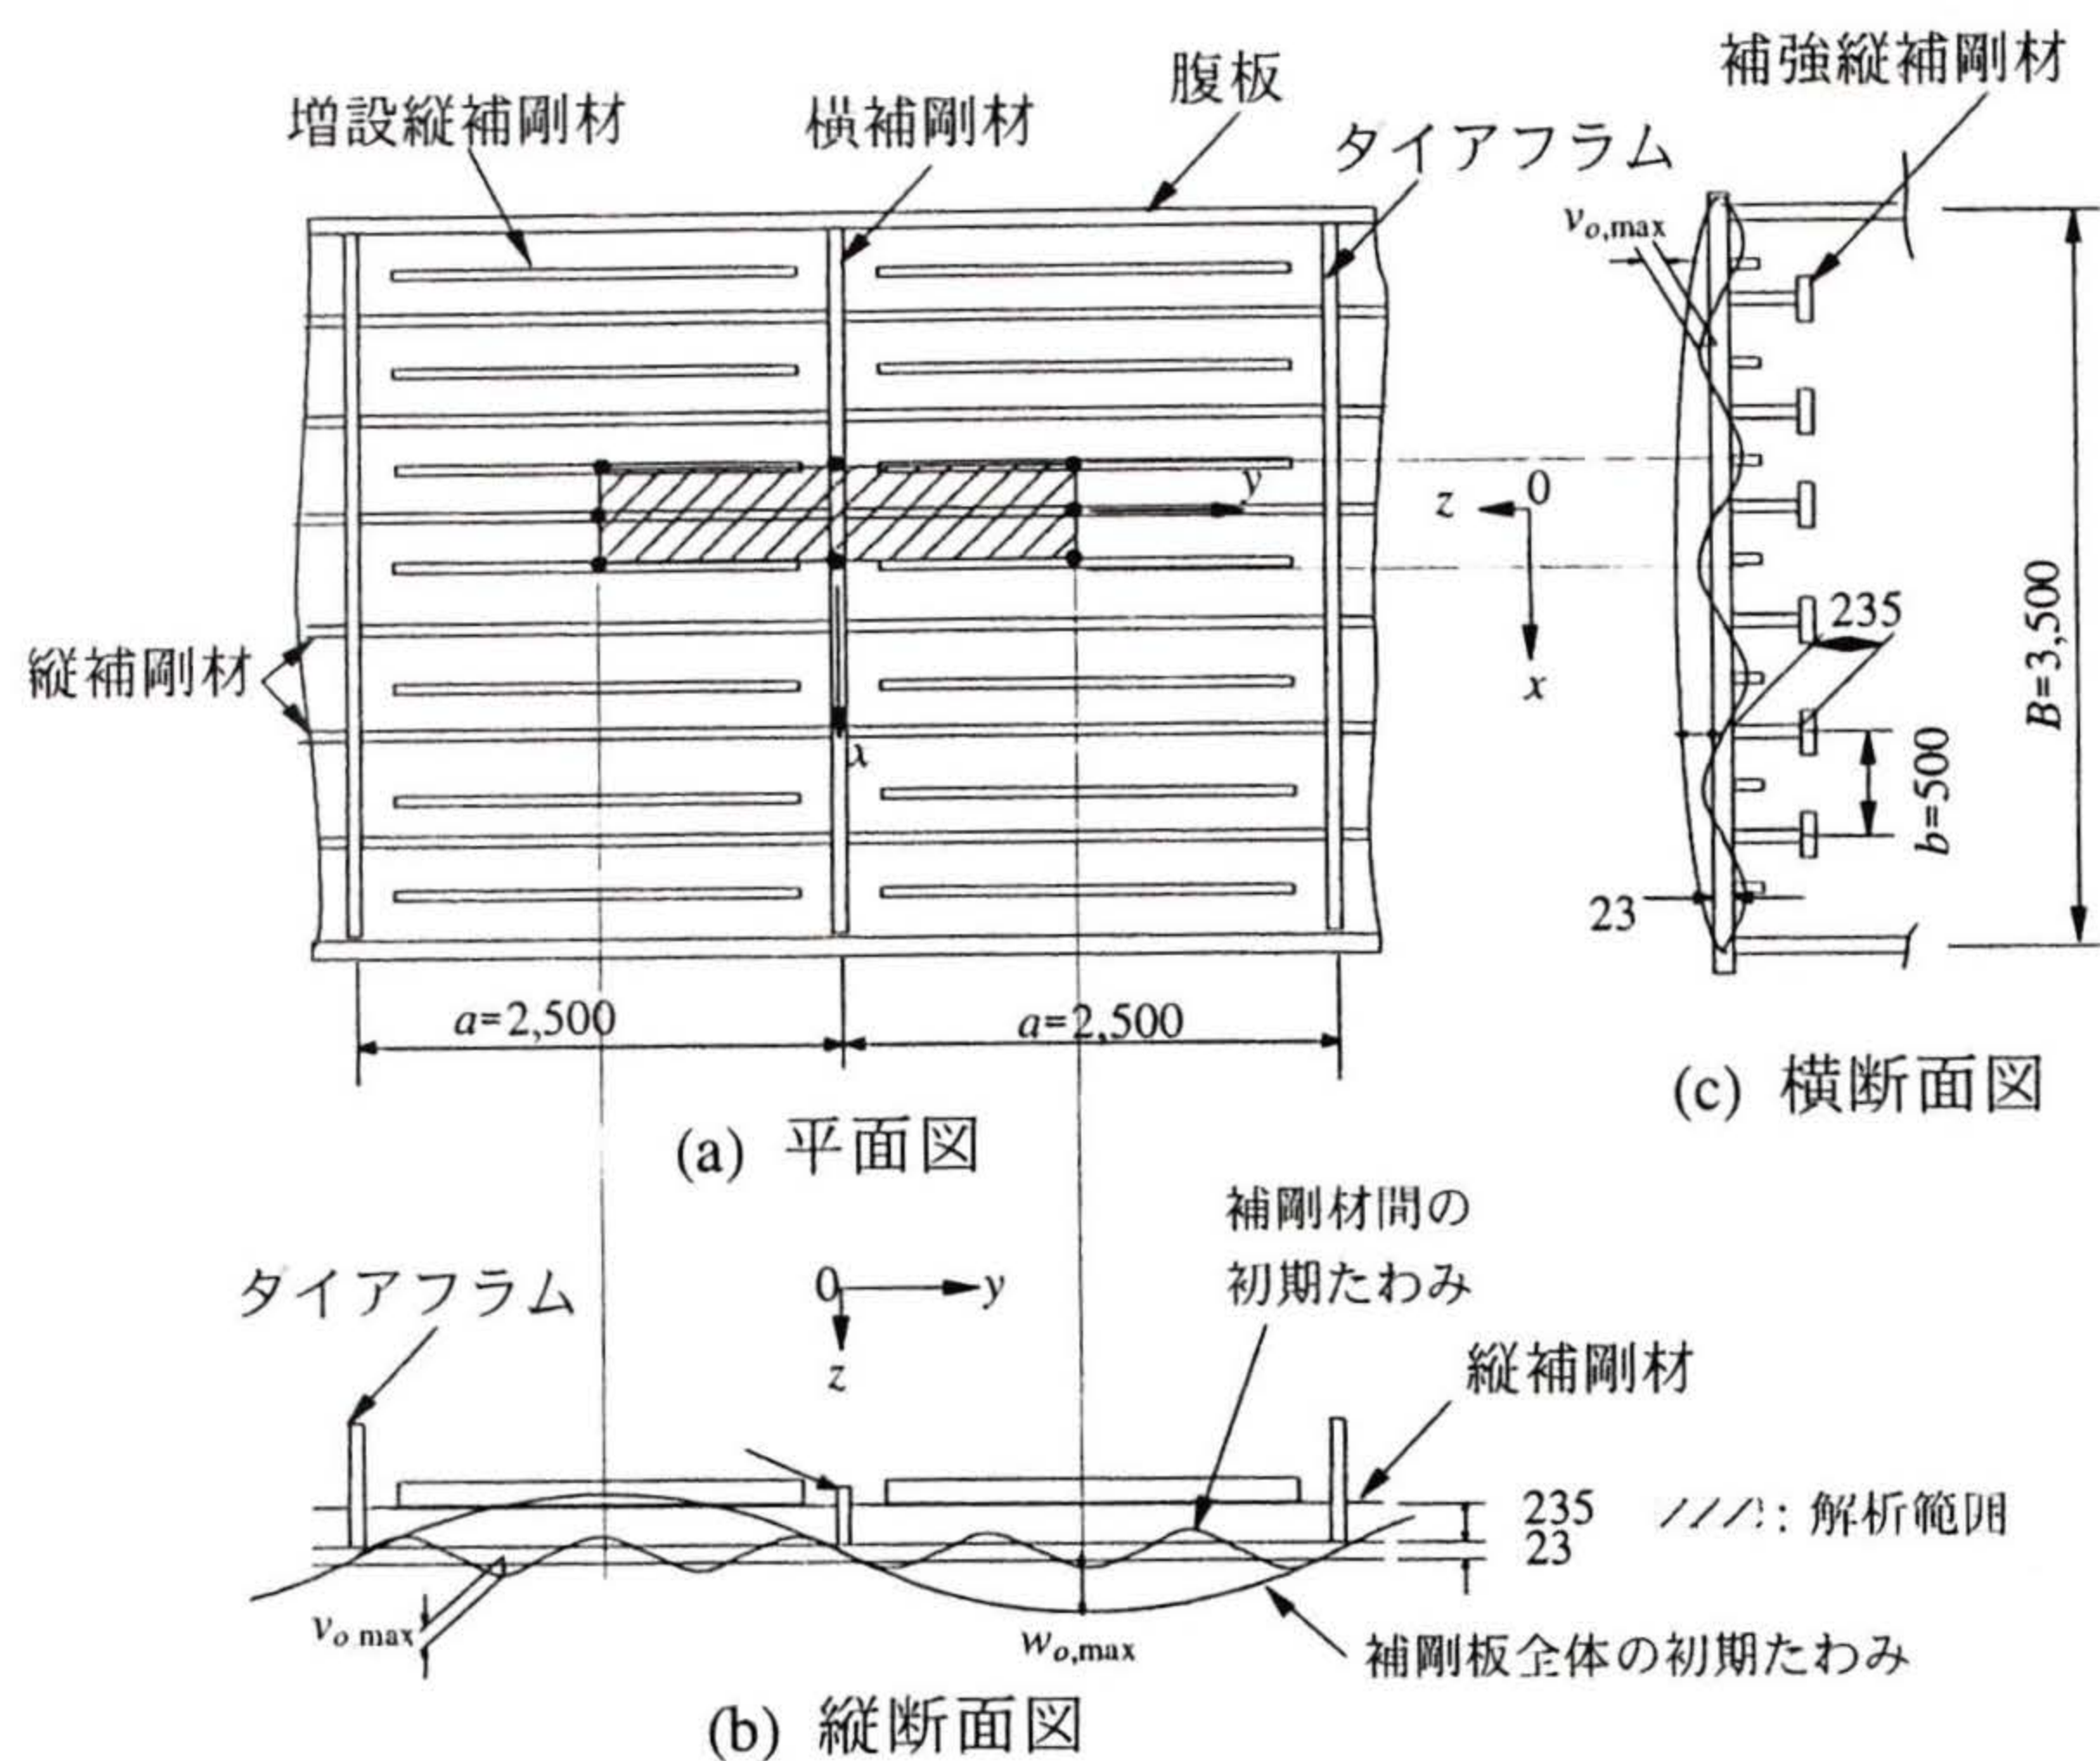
解析モデルと解析対象範囲（寸法単位：mm）
